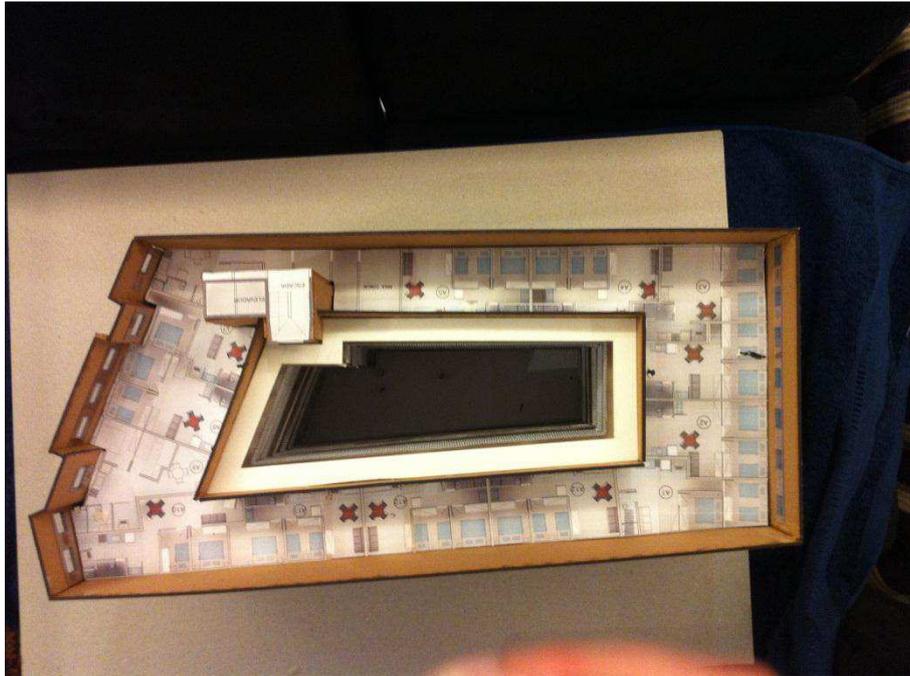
foto da maquete elaborada pelo grupo. Vista do 6º andar. Foto tirada pelo grupo.
